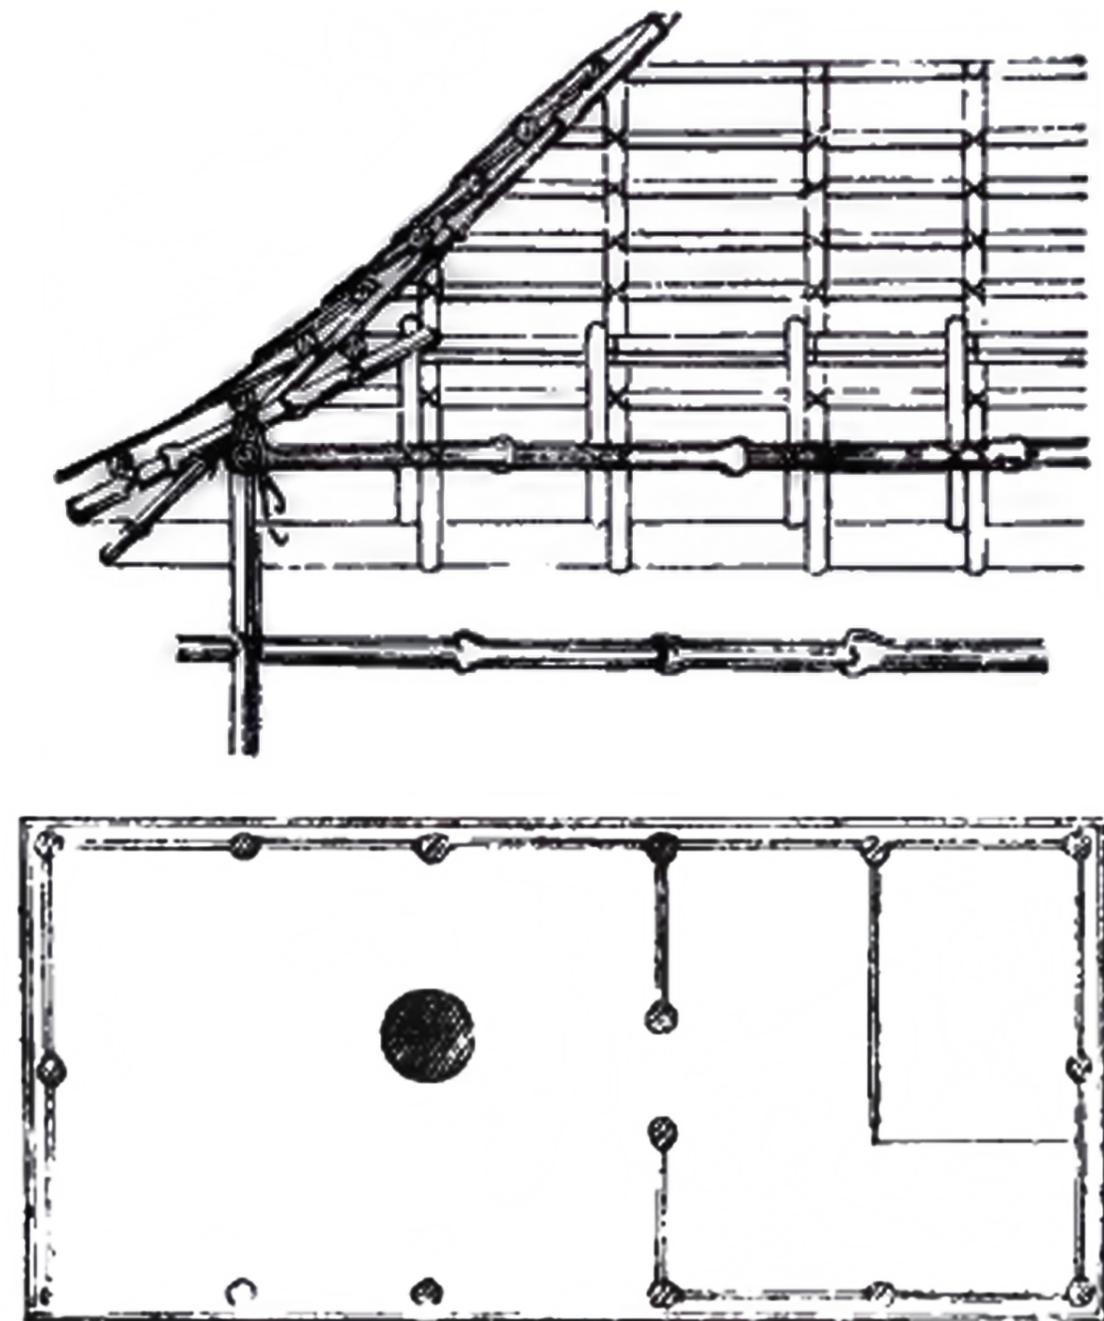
Detalhe da estrutura do telhado e planta da cabana caribenha
